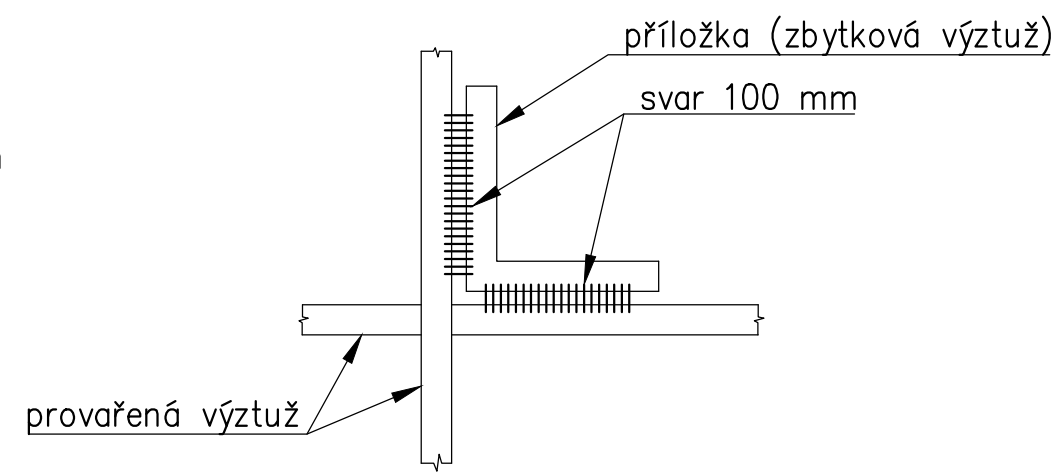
PODÉLNÉHO PROVAŘENÍ VÝZTUŽE
